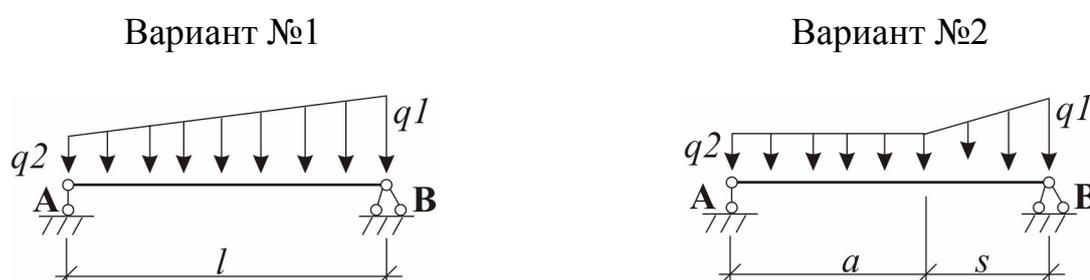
Варианты схем нагружения снеговой нагрузкой в местах перепада высот покрытия
